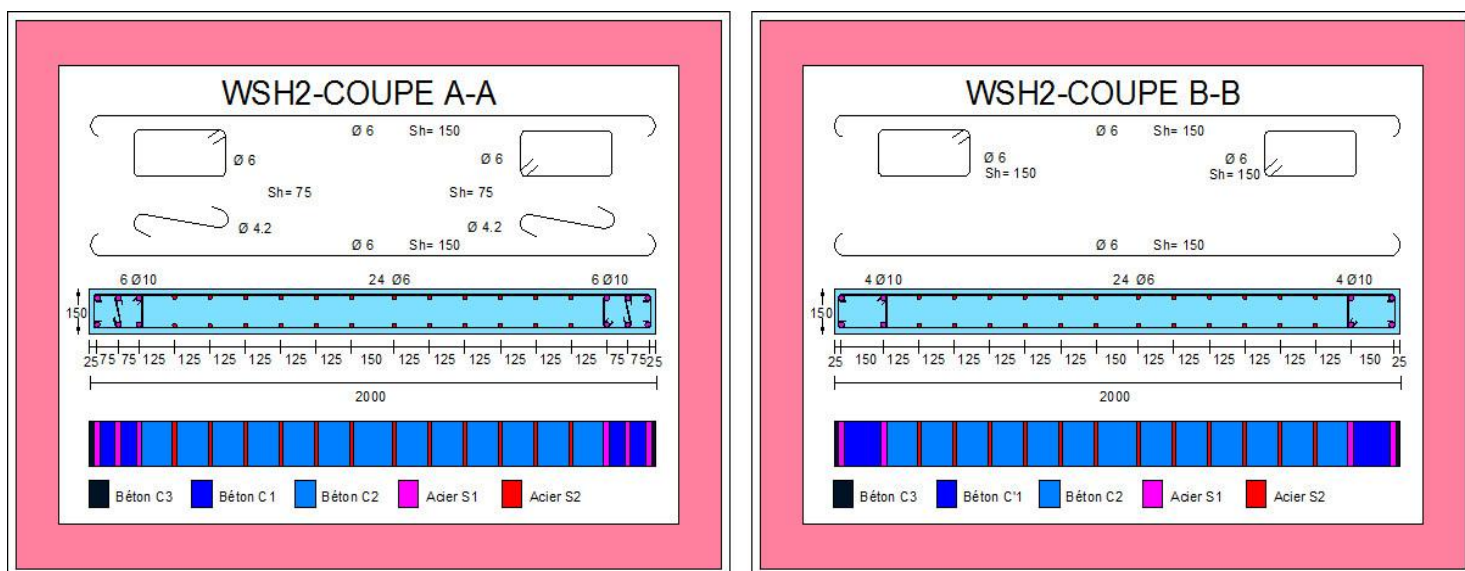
Ferrailage et modélisation multicouche de la section en béton armé, dimensions (mm) :
